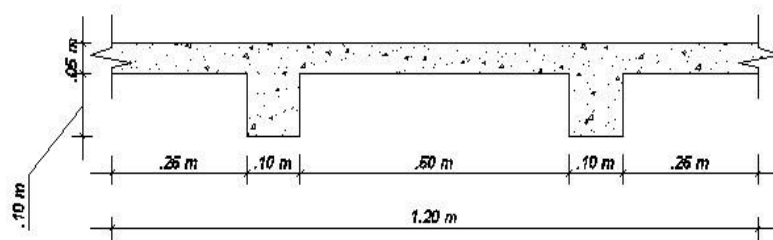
Vista transversal de la losa en 2 direcciones.
